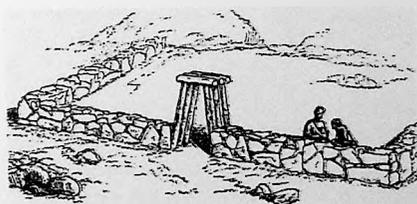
Viollet-Le-Duc, primeiro muro de cantaria
